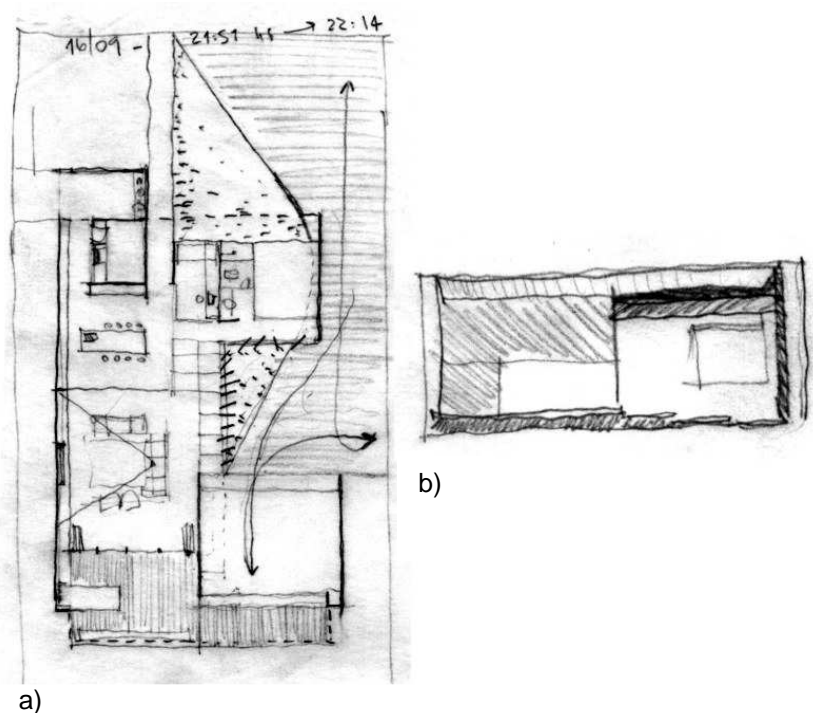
Planta e elevação com bloco suíte/garagem não girado
